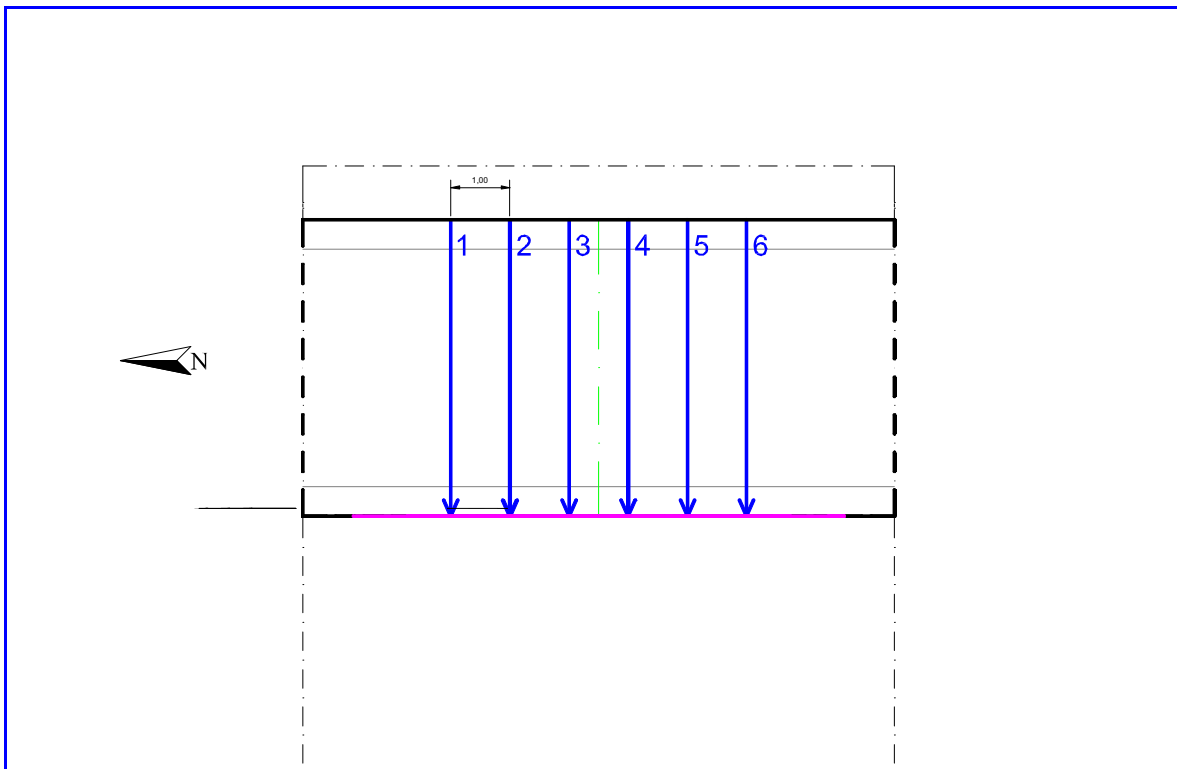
SP 14 - km 10+110 - Pianta dell'area di prova
